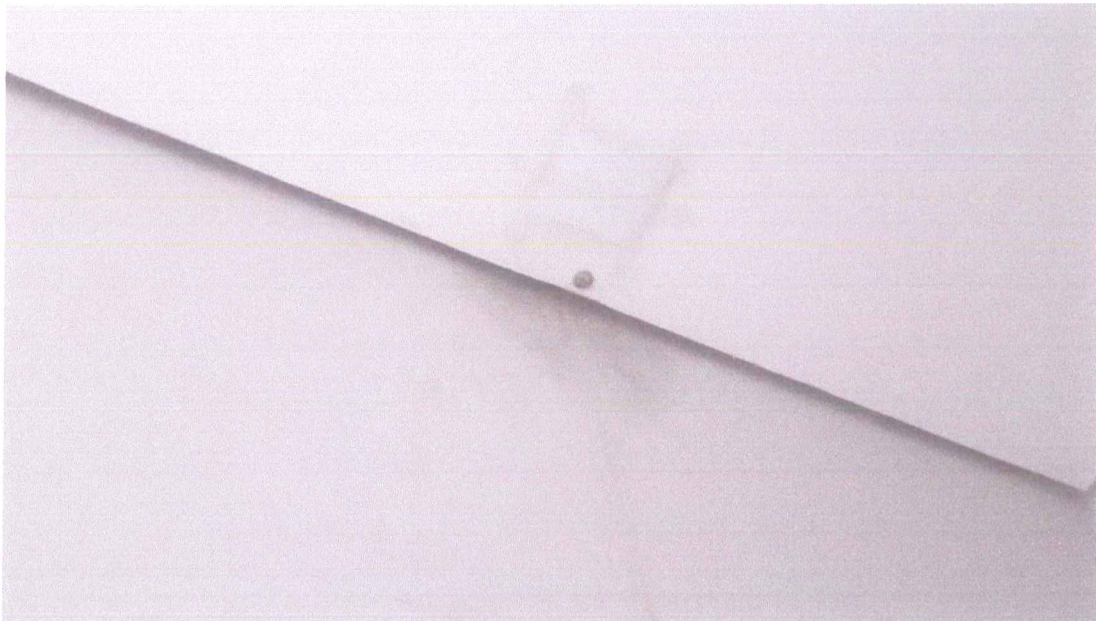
LAJE DA UNIDADE COM INFILTRAÇÃO
